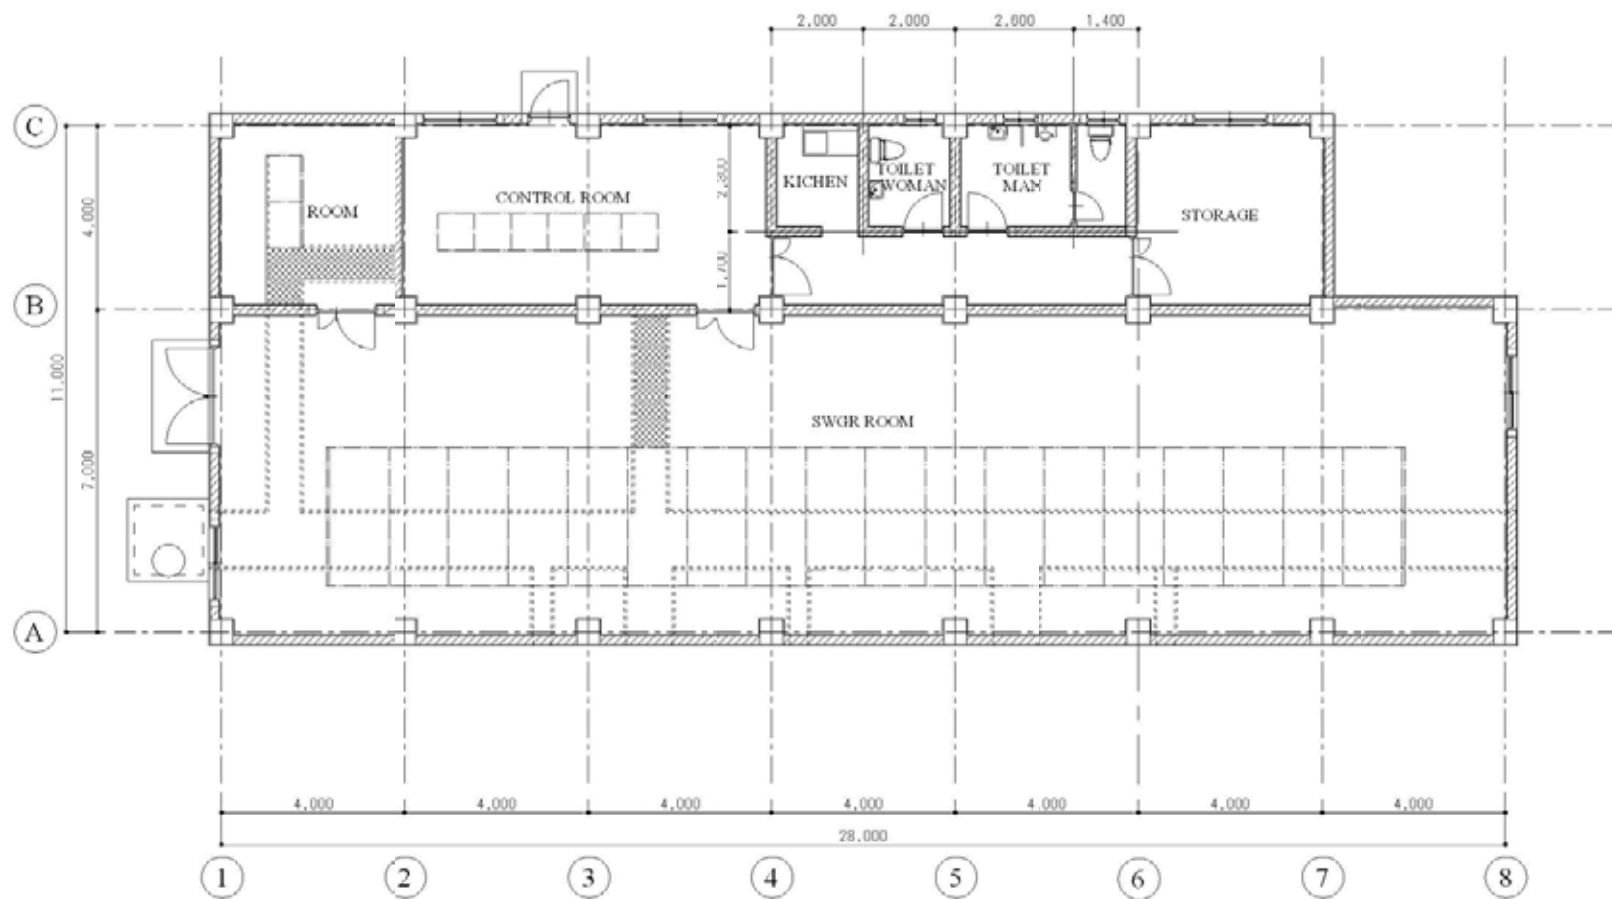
Mtoni 变電所 制御棟 平面図
